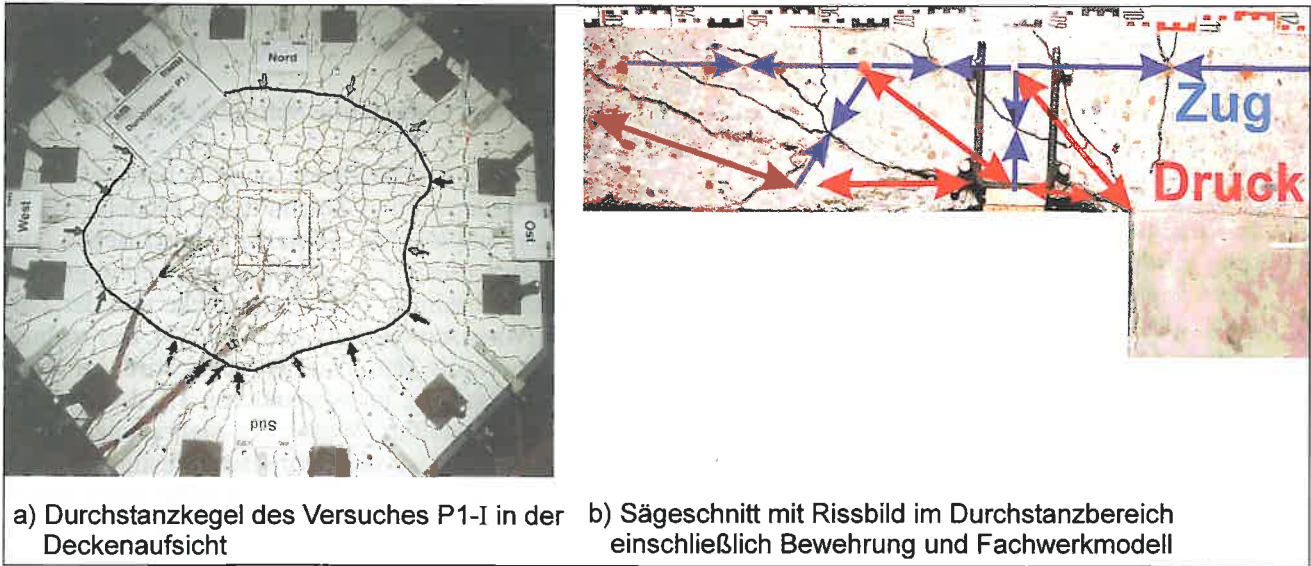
Rissbild und Sägeschnitt des Versuchskörpers P1-I
